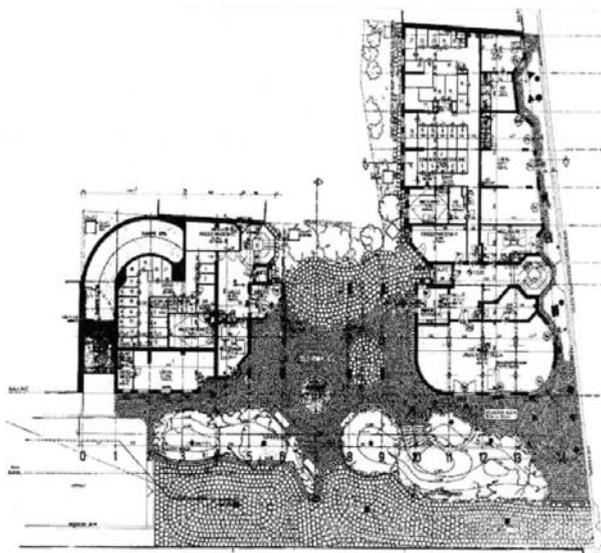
План первого нежилого этажа дома Хундертвассера – Кравина Хаус
